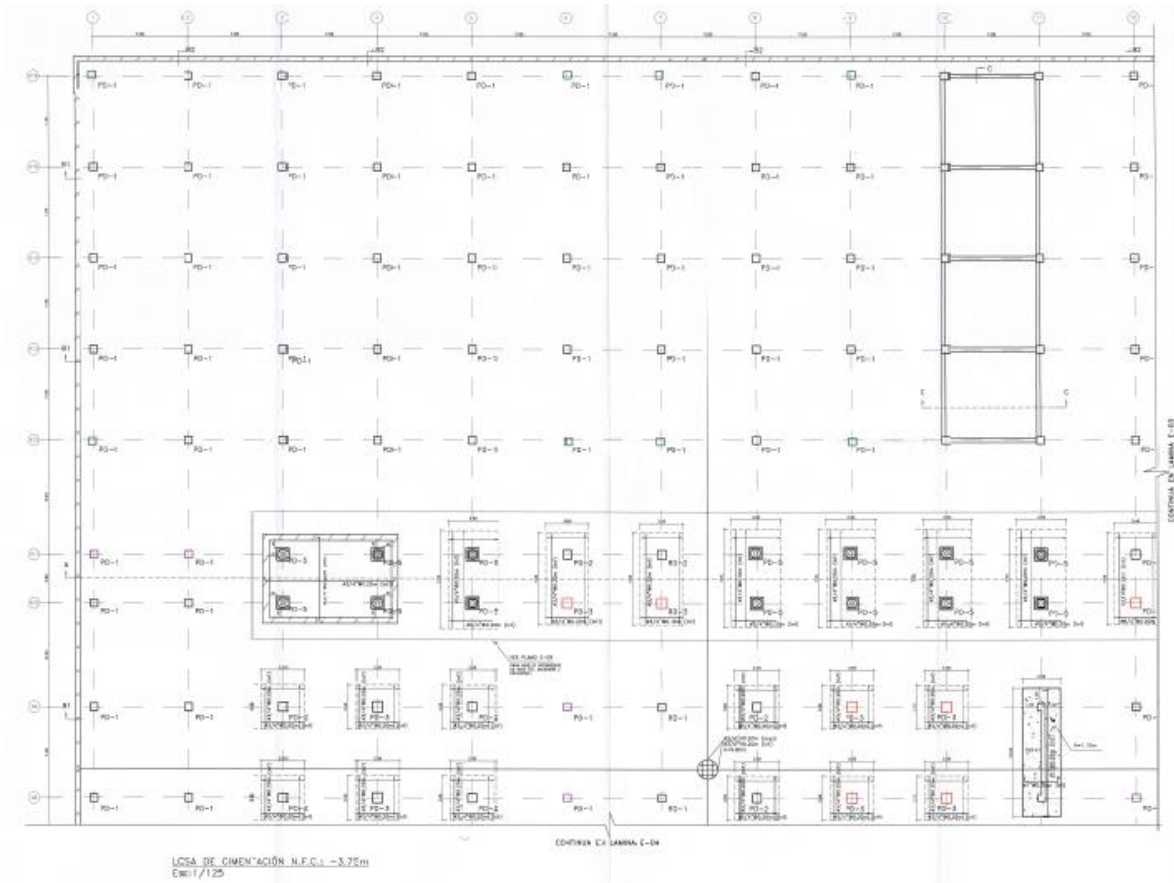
Planta de Losa de Cimentación de la edificación hospitalaria.
